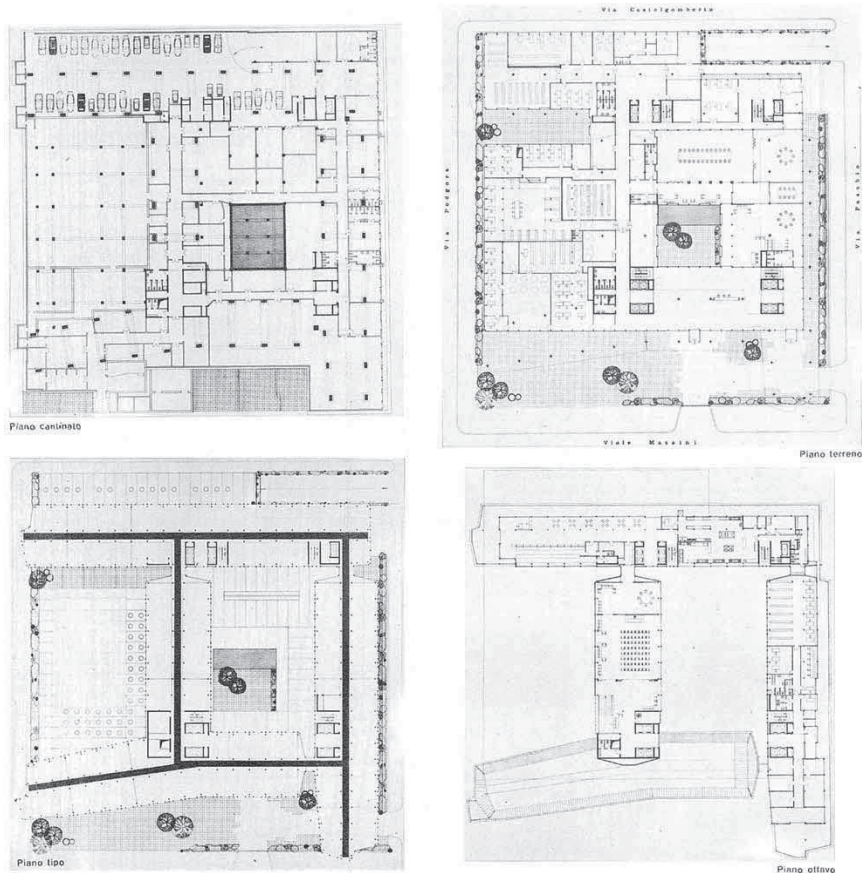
Pianta dell'edificio: in alto, il piano interrato e il piano terra; in basso il piano tipo e il piano ottavo (da *L'architettura. Cronache e storia*, n. 142, 1967)
